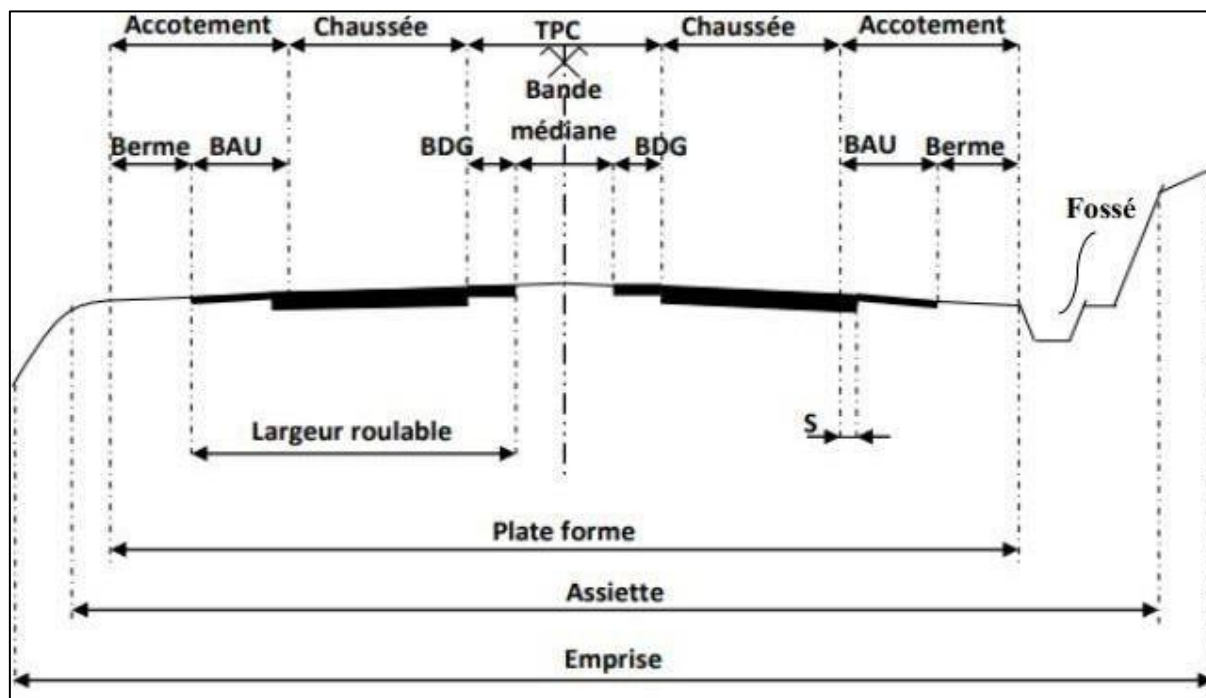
Les éléments du profil en travers type d'une route à double chaussée
